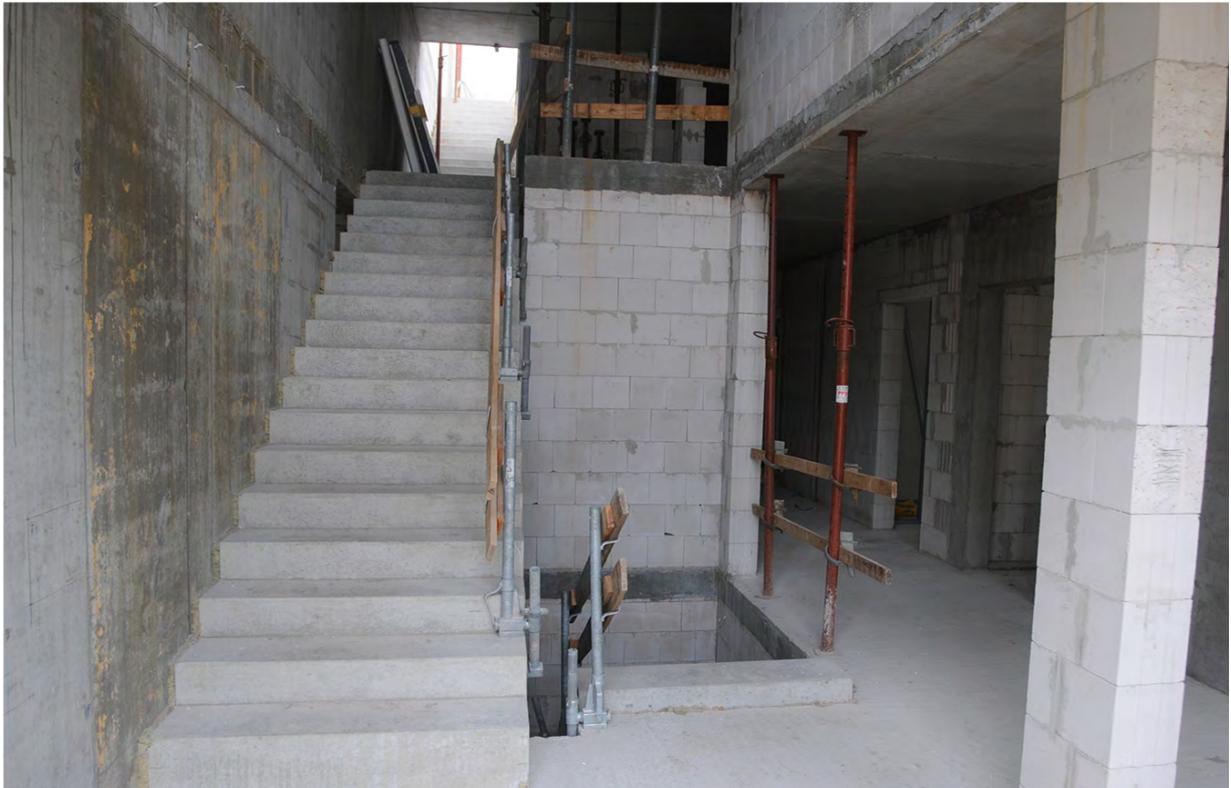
Haupttreppe - Erdgeschoss, 30.08.2018
